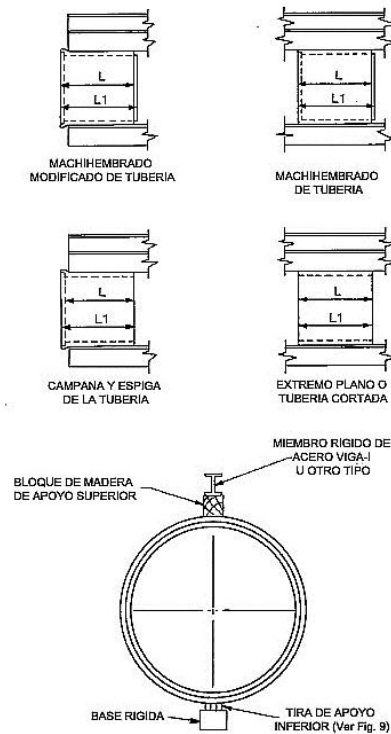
Método de Aplicación de la Carga, Ensayo en Tres Apoyos, Tubería Circular
